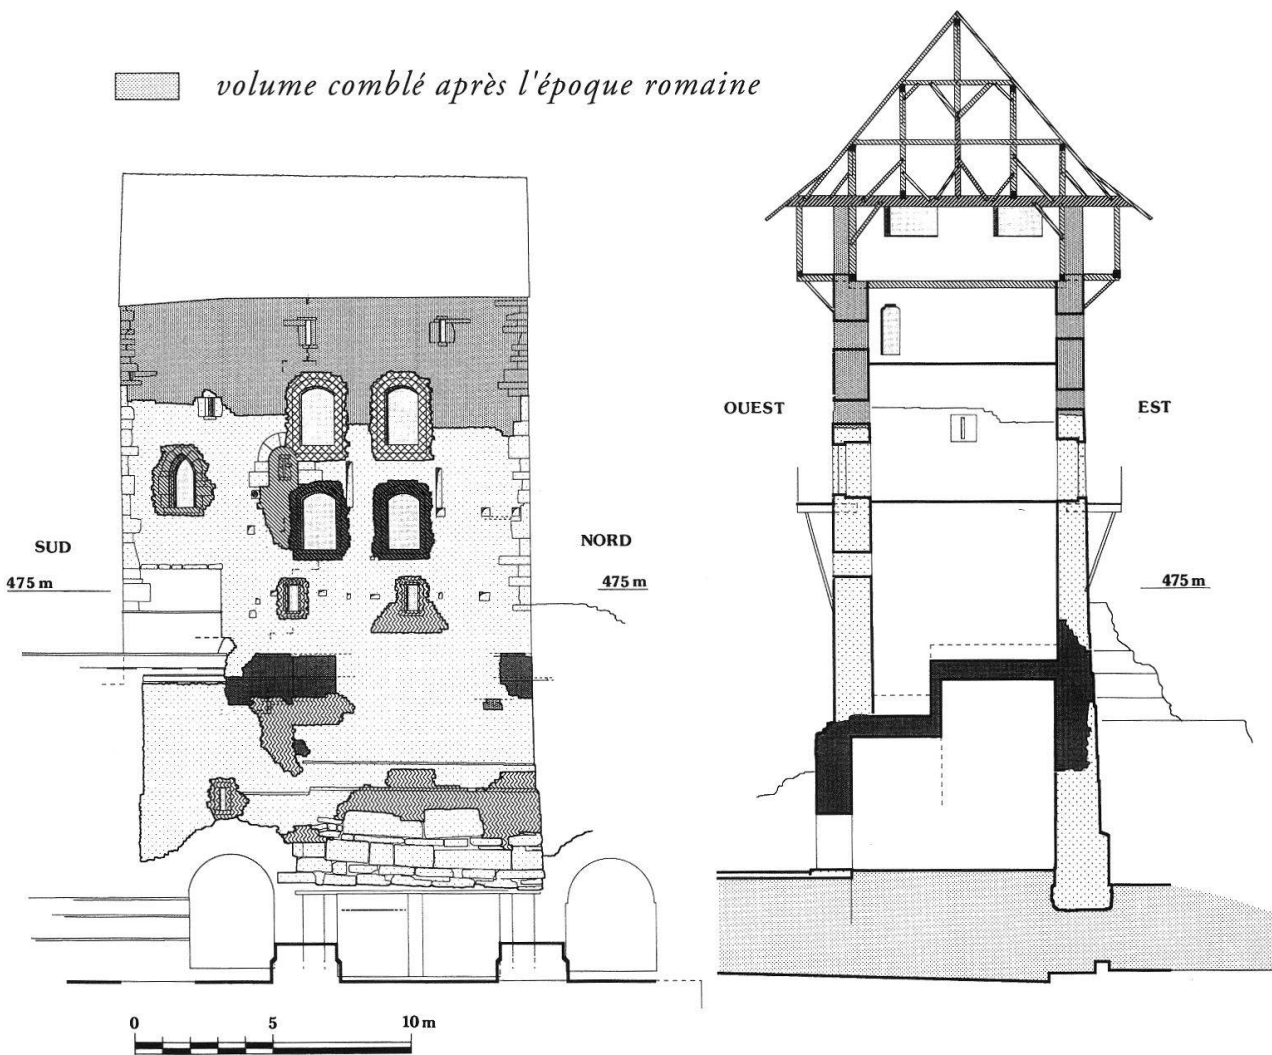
AVENCHES – Tour de l’amphithéâtre. Élévation de la façade orientale. Coupe avec reconstitution de la superstructure médiévale, vers 1450. (Dessin J. Sarott, AAM)
